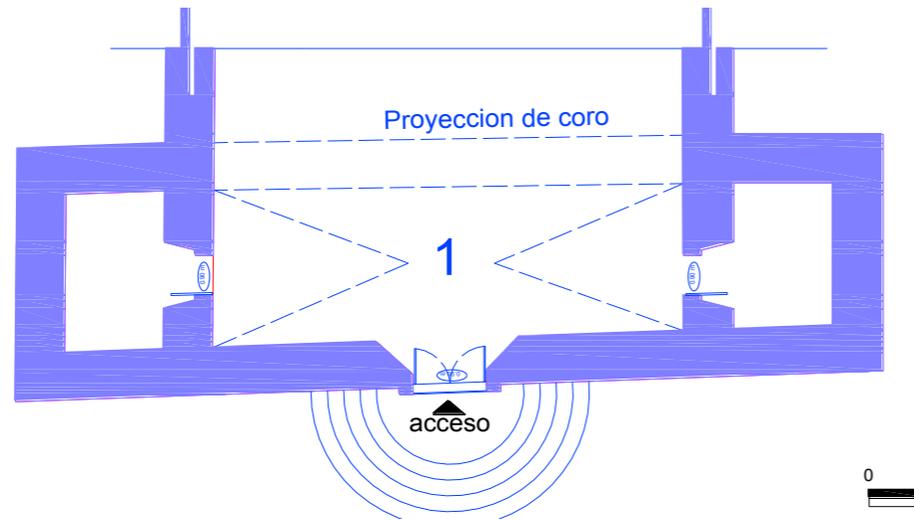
Planta de la fachada hipotética del templo del Señor de los Trabajos
